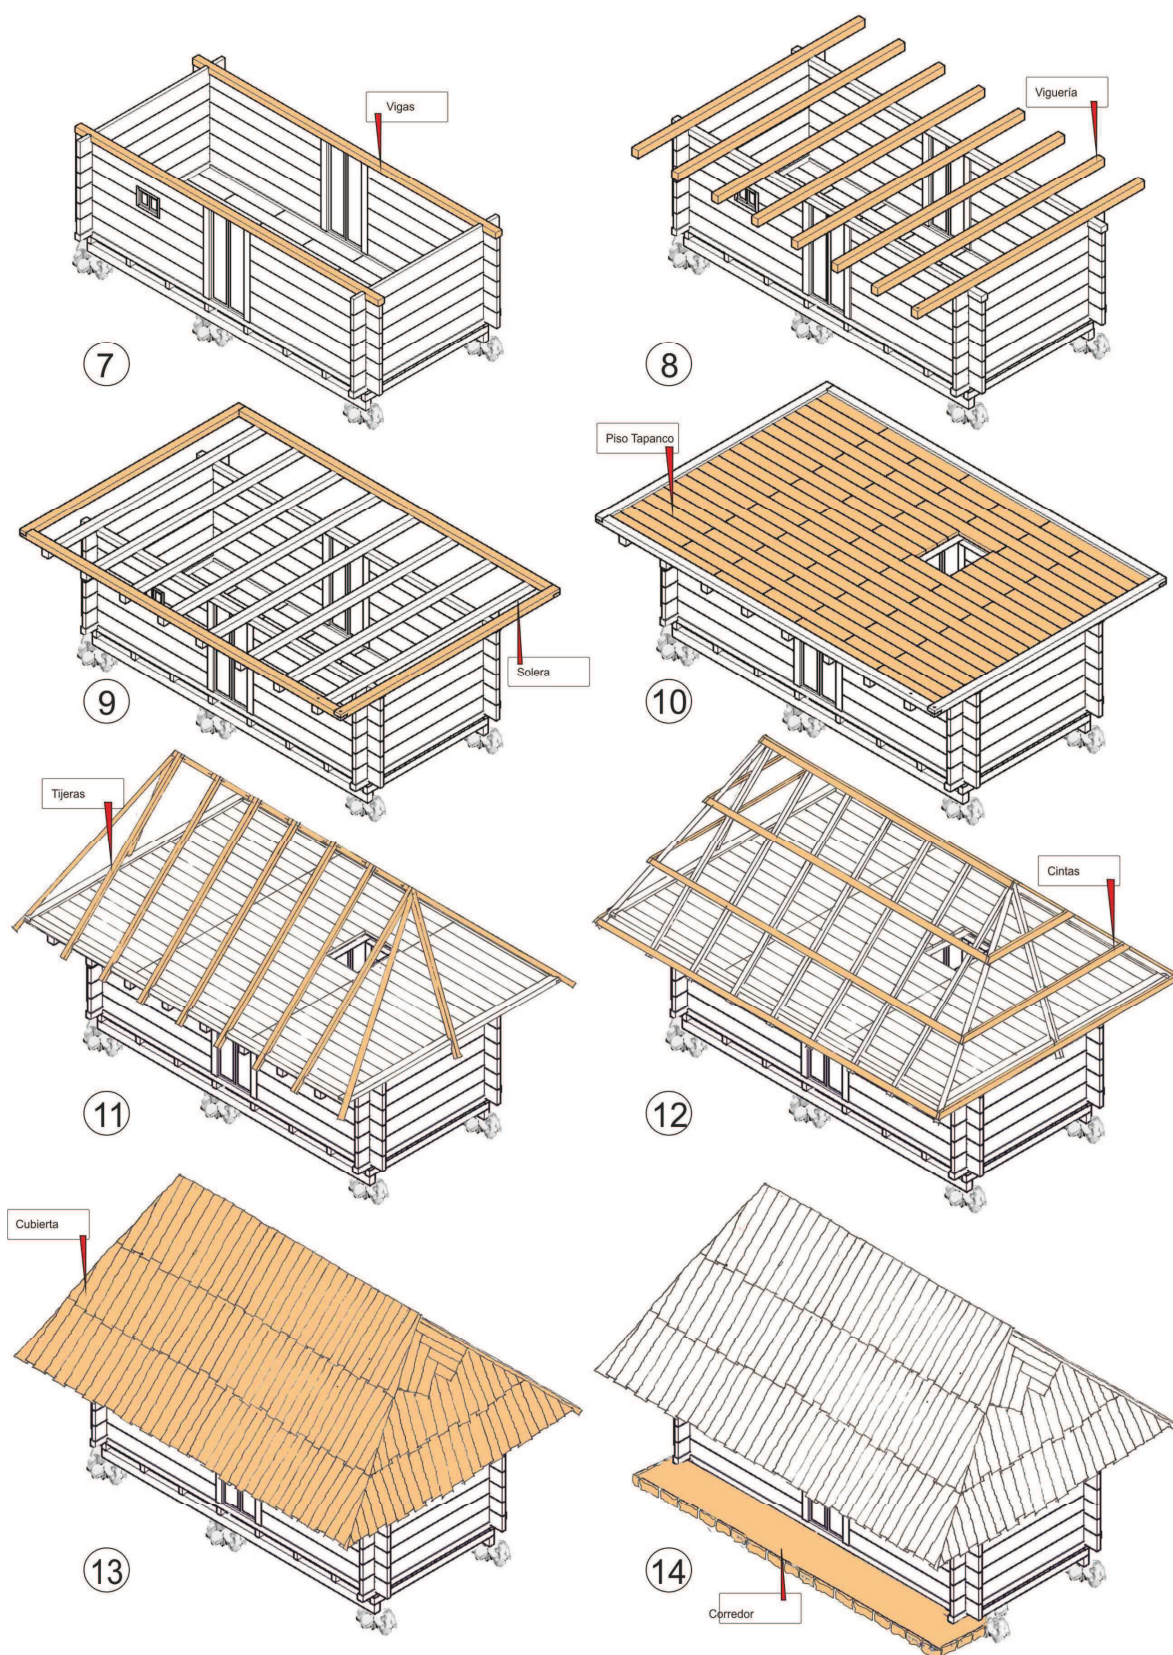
Sistema constructivo cerco de viguetas labradas.
